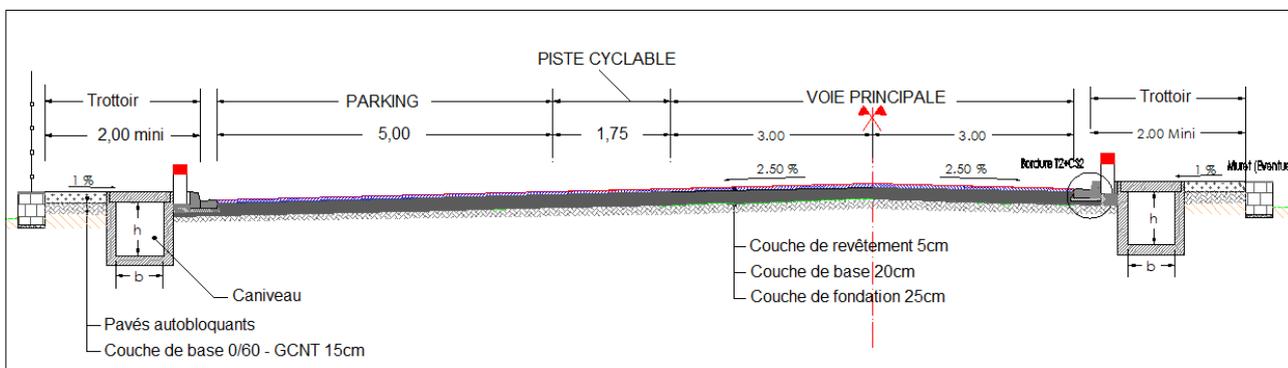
CHAUSSEE AVEC 1 PISTE CYCLABLE ET 1 VOIE DE PARKING
